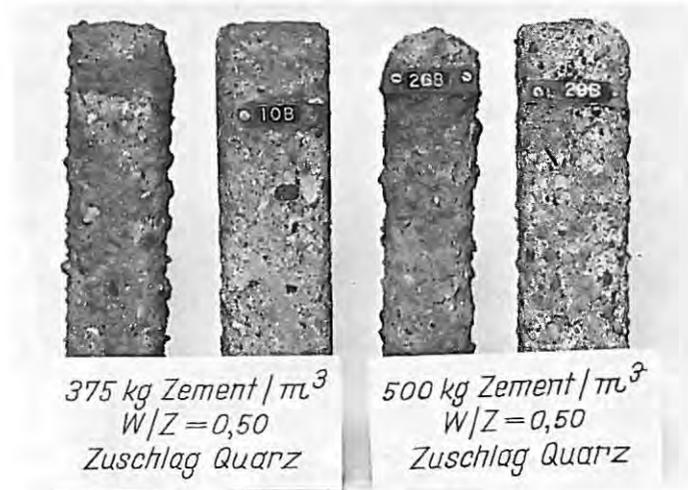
Feinbetonprismen nach 20 Jahren Lagerung in Wasser mit kalklösender Kohlensäure; Einfluß der Zementmenge
